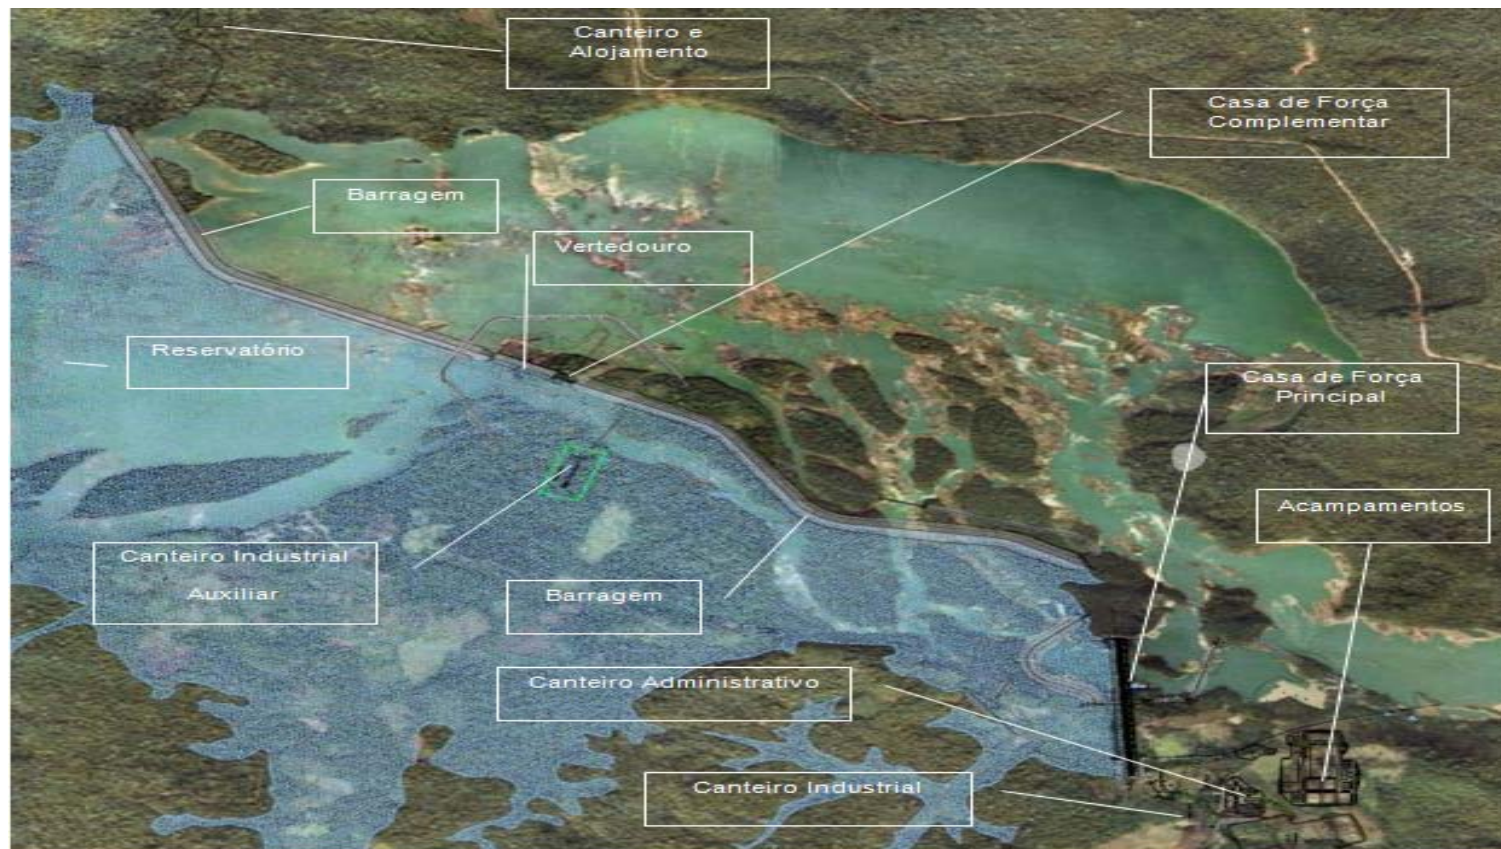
/01 – Esquema do Arranjo Geral das Obras, Canteiros e Acampamentos
